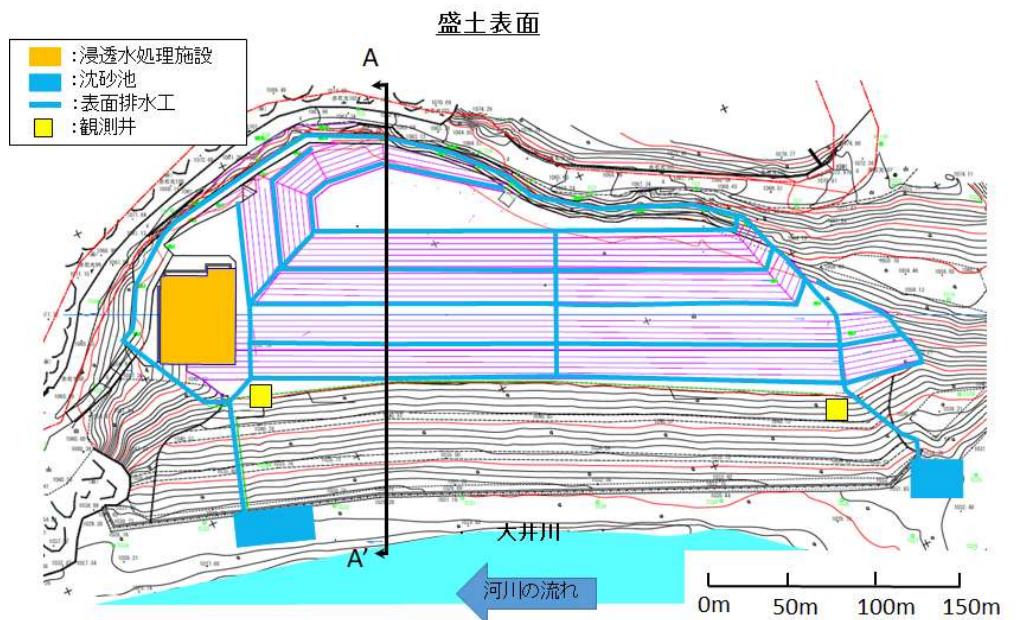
藤島発生土置き場（対策土）の排水設備計画平面図
